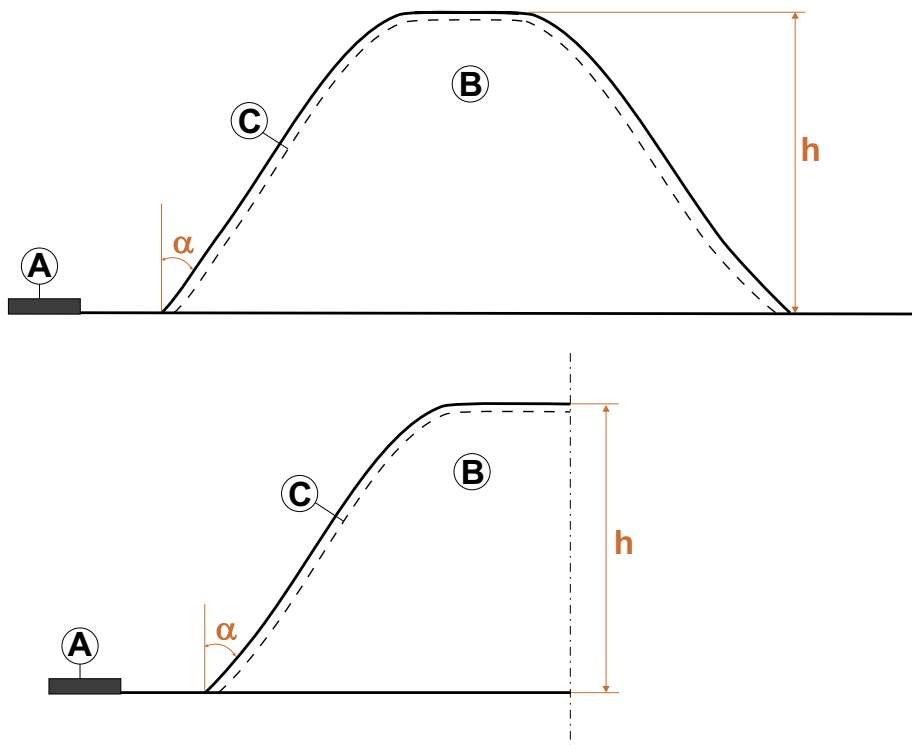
Schemat konstrukcji typowych ekranów przegrodowych.
